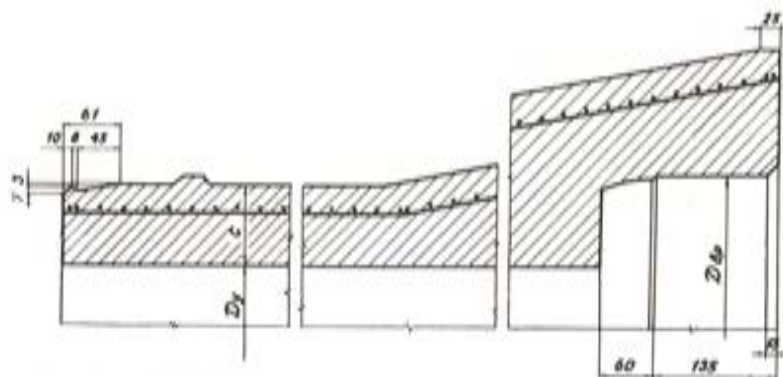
Sección-tipo de una tubería, de hormigón pretensado, fabricada por vibro-compresión.
